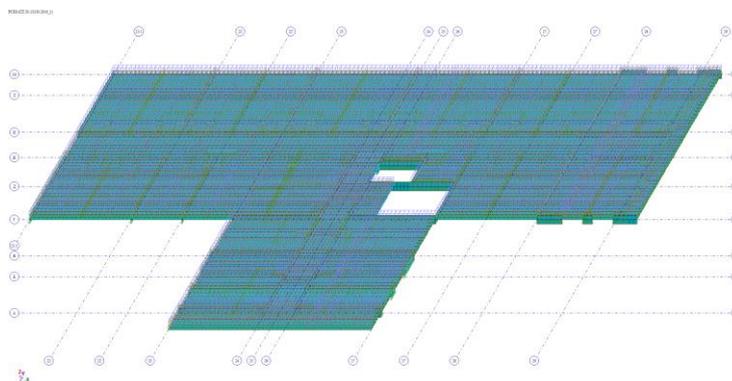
Схема плиты перекрытия с приложенными нагрузками
